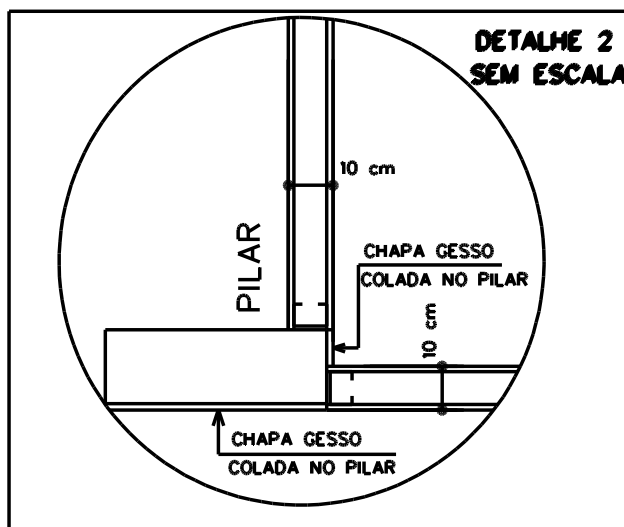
Detalhe de arremate de parede de gesso acartonado com estrutura.
